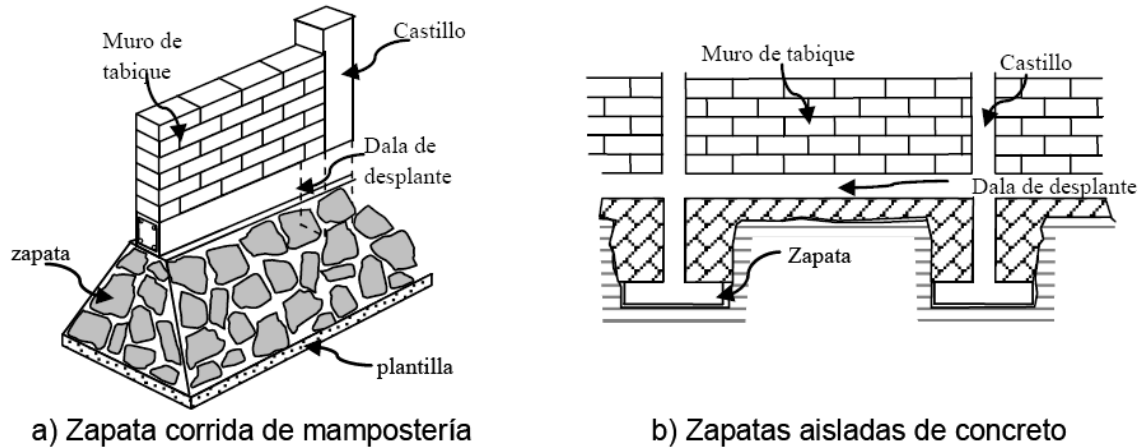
Cimentaciones comunes en viviendas a base de muros de mampostería (fuente: Sánchez y Navarro, 2011)
